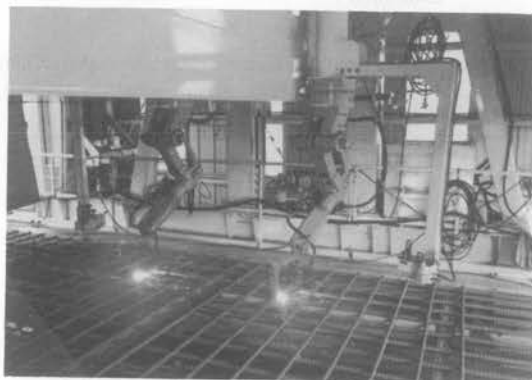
鉄筋籠自動溶接ロボット鉄筋溶接状況
